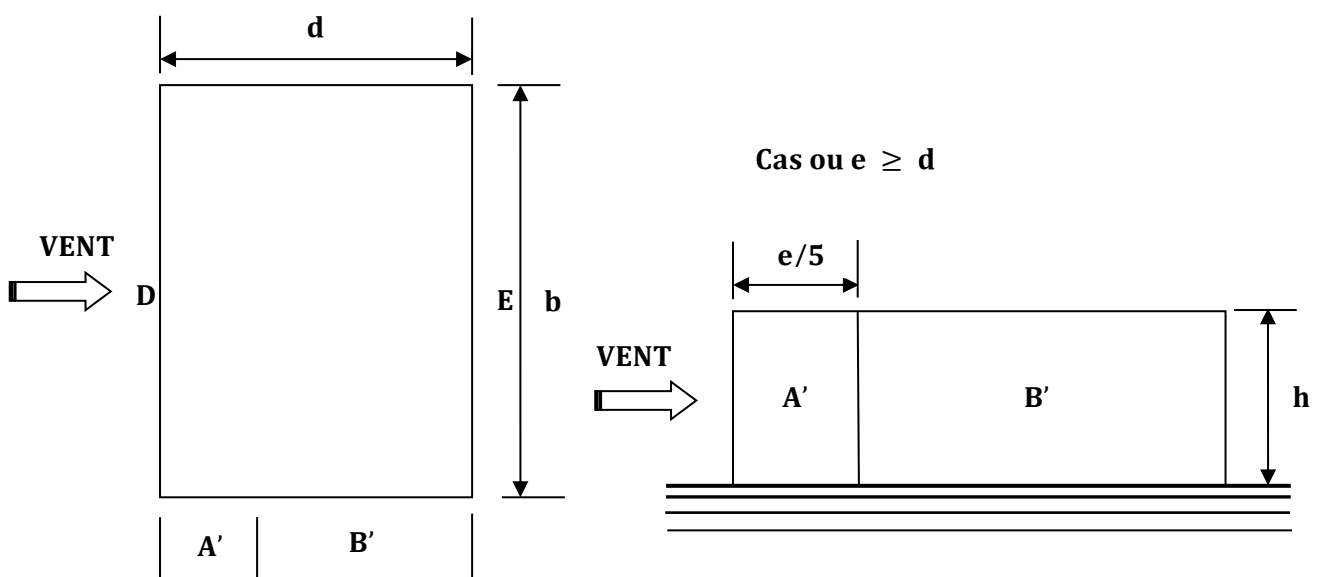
Vue en plan et vue en élévation, sens XZ.
